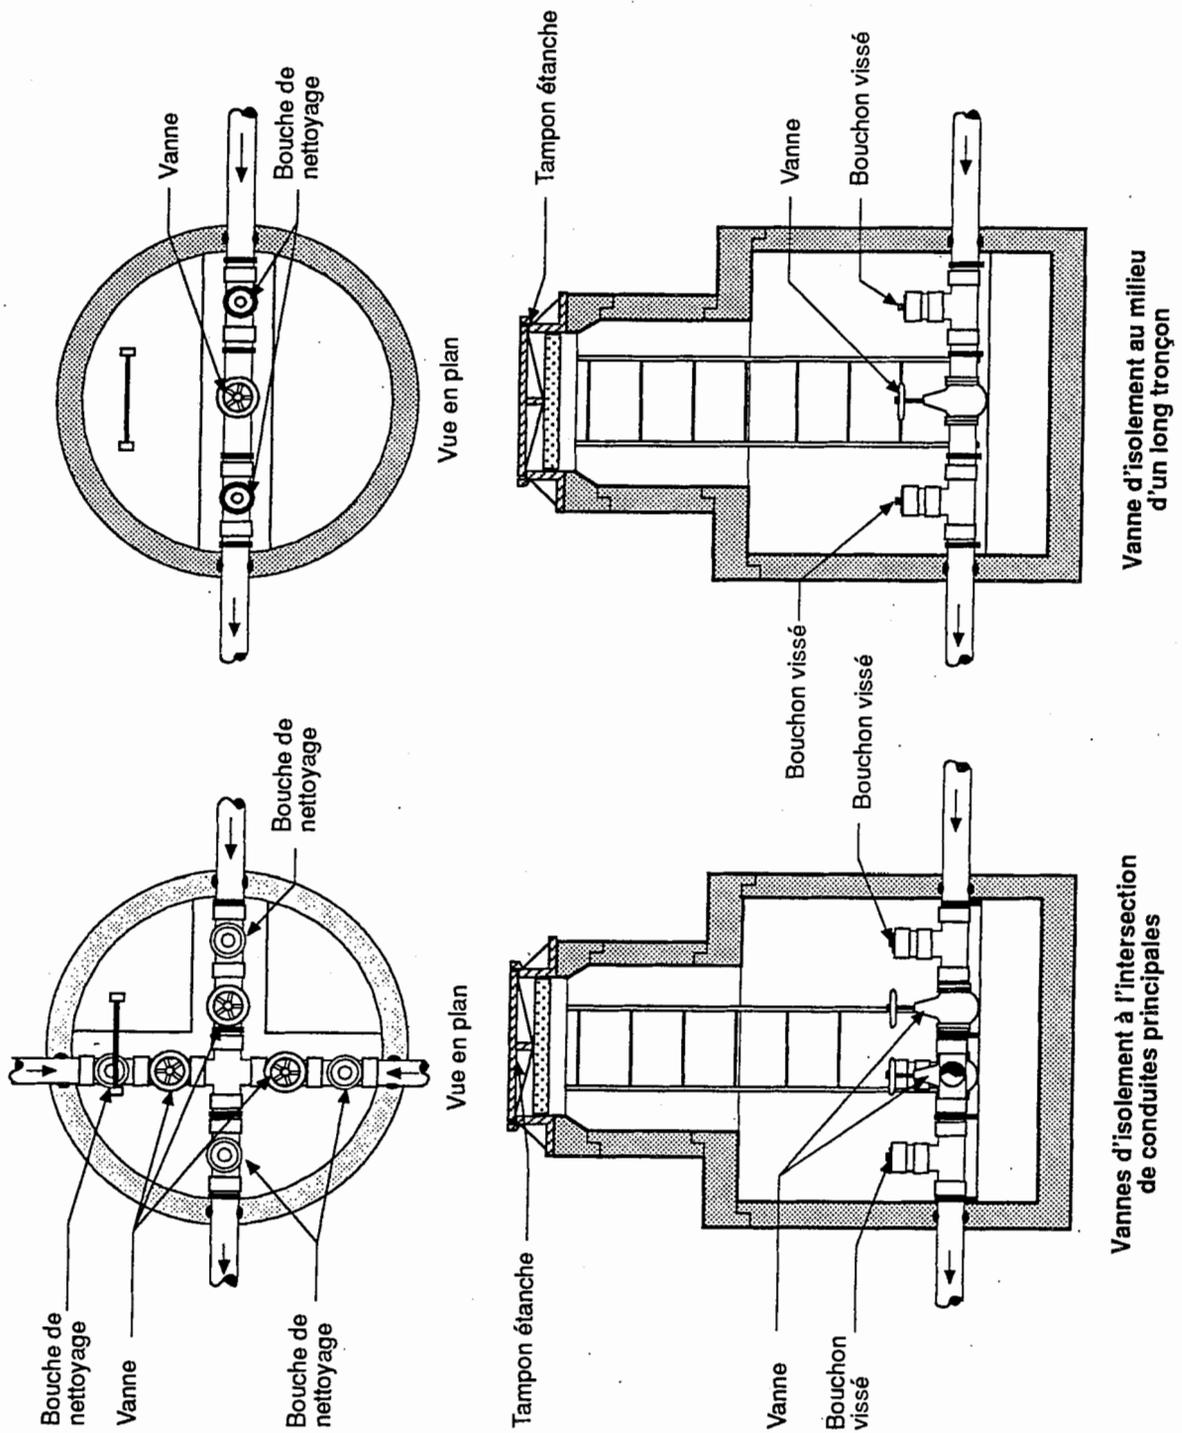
Un arrangement type de vannes d'isolement avec bouches de nettoyage
